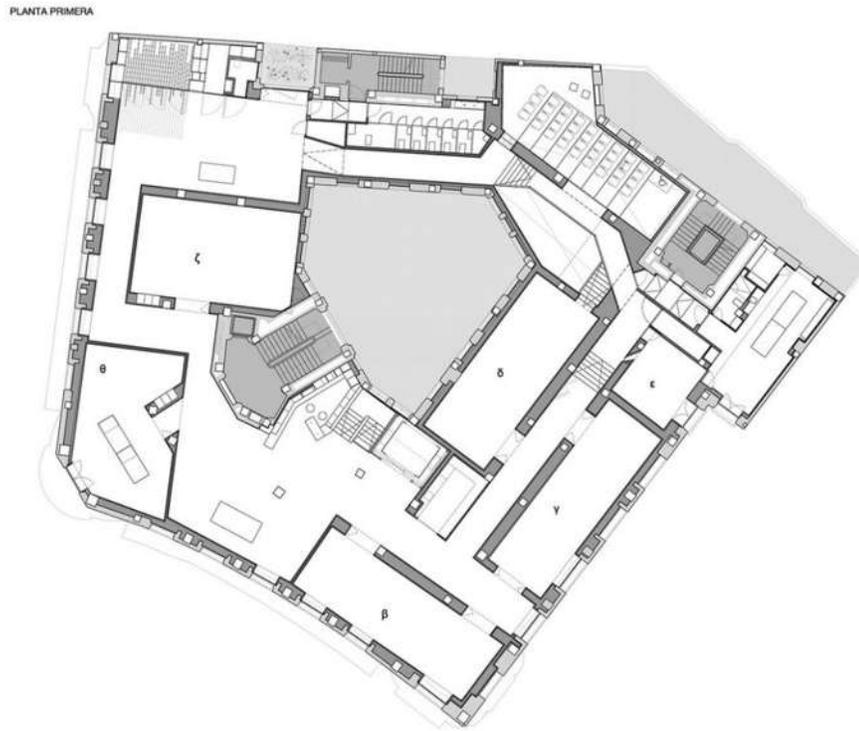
| Plano Arquitectónico del Espacio Solo.
